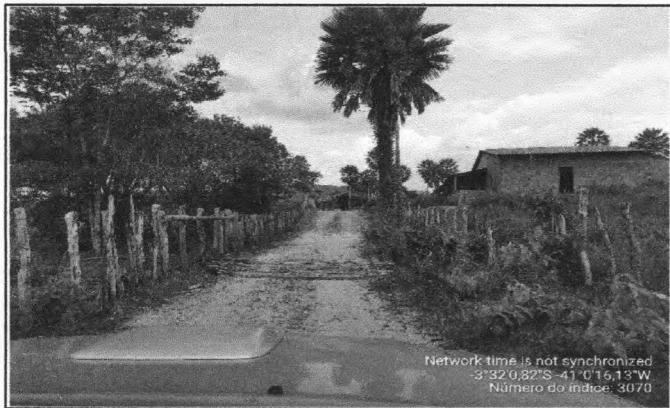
LOCAL DA CONSTRUÇÃO-BUEIRO CAPEADO
